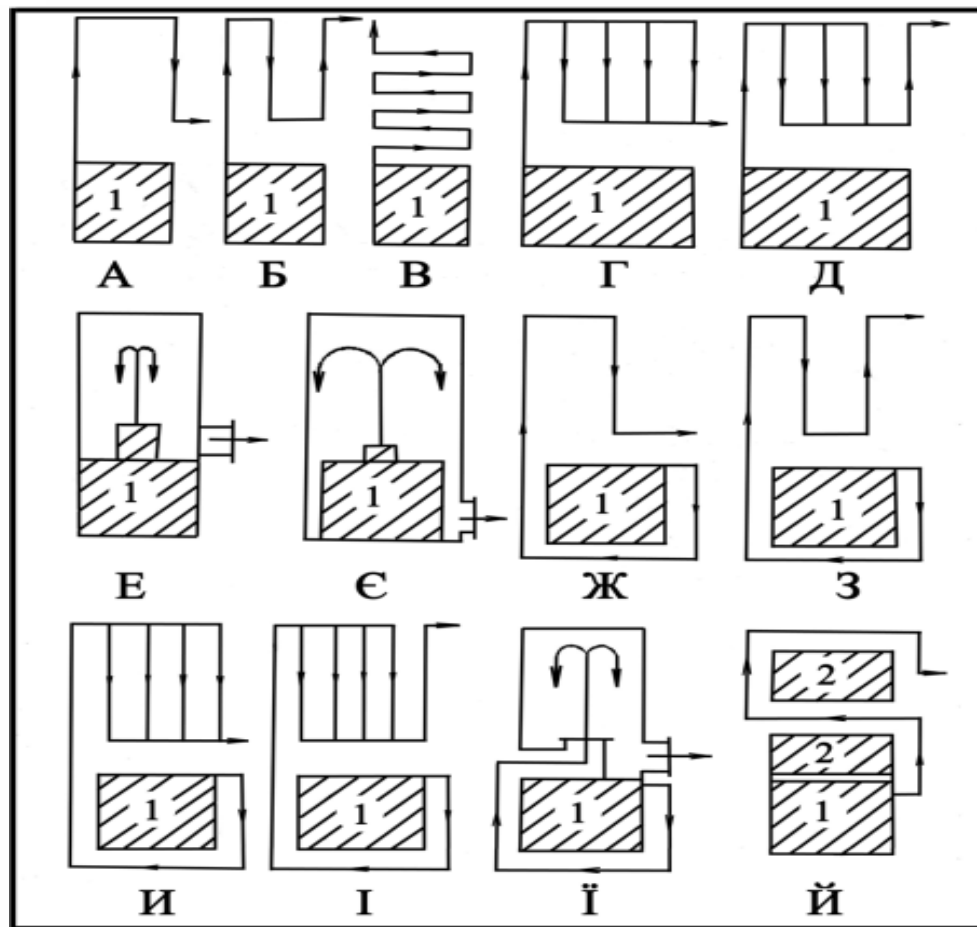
Схеми руху газів в кімнатних печах: А – однооборотна з рухом газів по каналах, які з'єднані послідовно; Б – двооборотна з рухом газів по каналах, які з'єднані послідовно; В – багатооборотні з короткими вертикальними каналами; Г – однооборотна з рухом газів по каналах, які з'єднані паралельно; Д – двооборотна з рухом газів по каналах, які з'єднані паралельно; Е, Є – з вільним рухом газів – безканалі; Ж-І – з рухом газів по комбінованій схемі каналів з нижнім прогрівом; Й – з рухом газів по комбінованій схемі каналів з повітронагрівальною камерою
